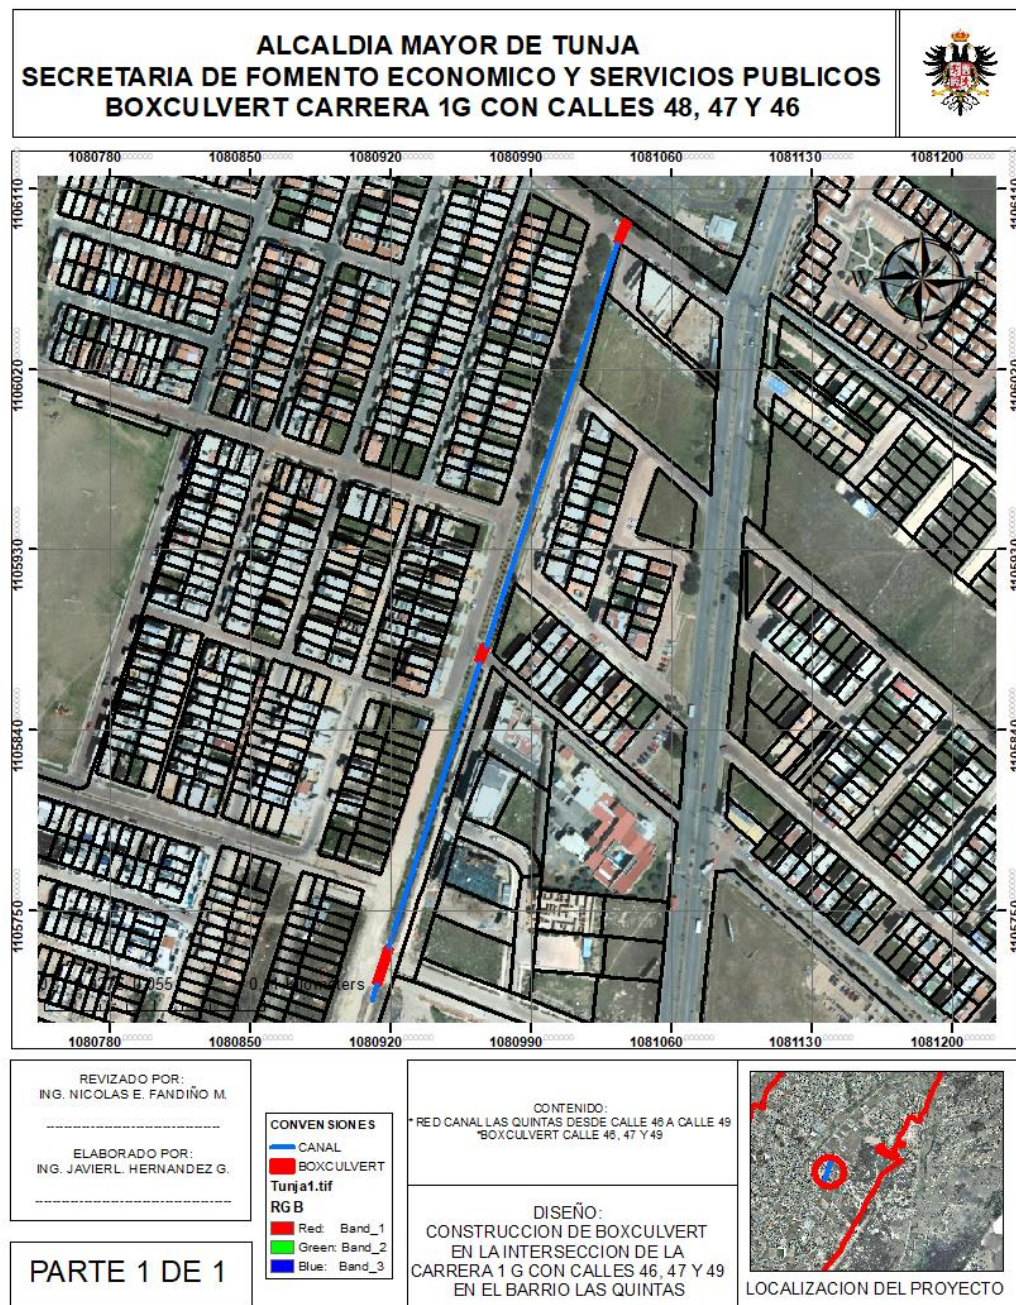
Proyección de Canal Carrera 1G con Calles 46, 47 y 49
